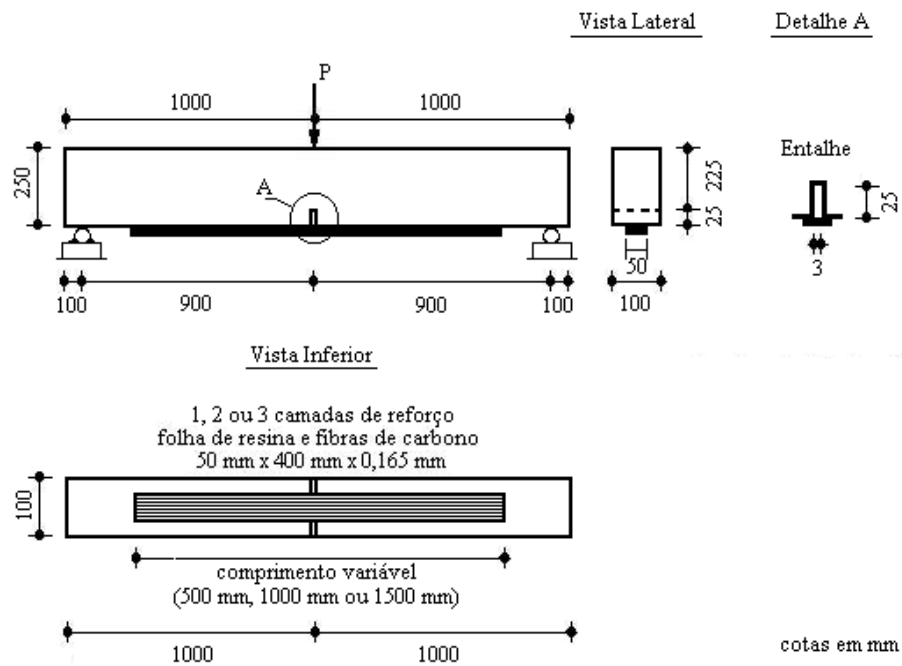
Reforço à Flexão das Vigotas de Concreto Armado
